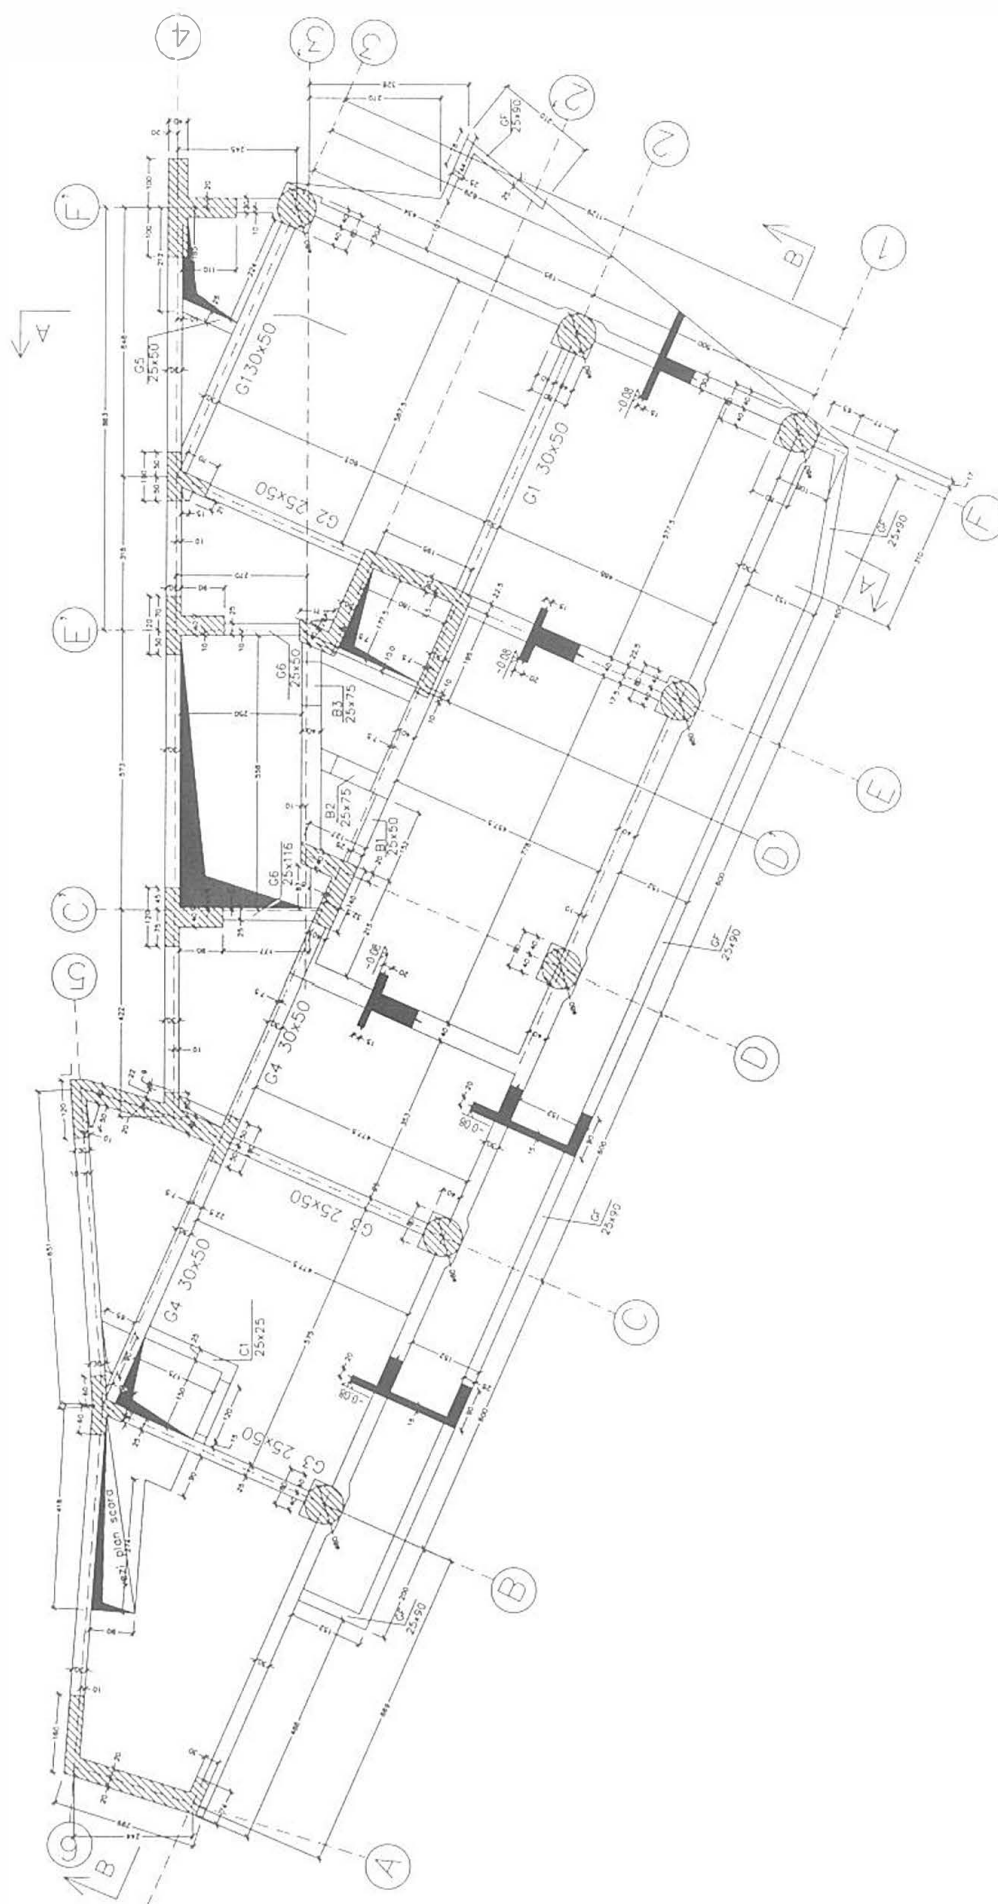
Plan cofraj planșeu peste subsol (la cota -0,08 m)
